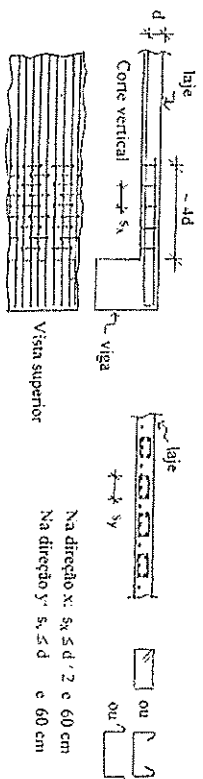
Armadura para cisalhamento formada por estribos verticais
